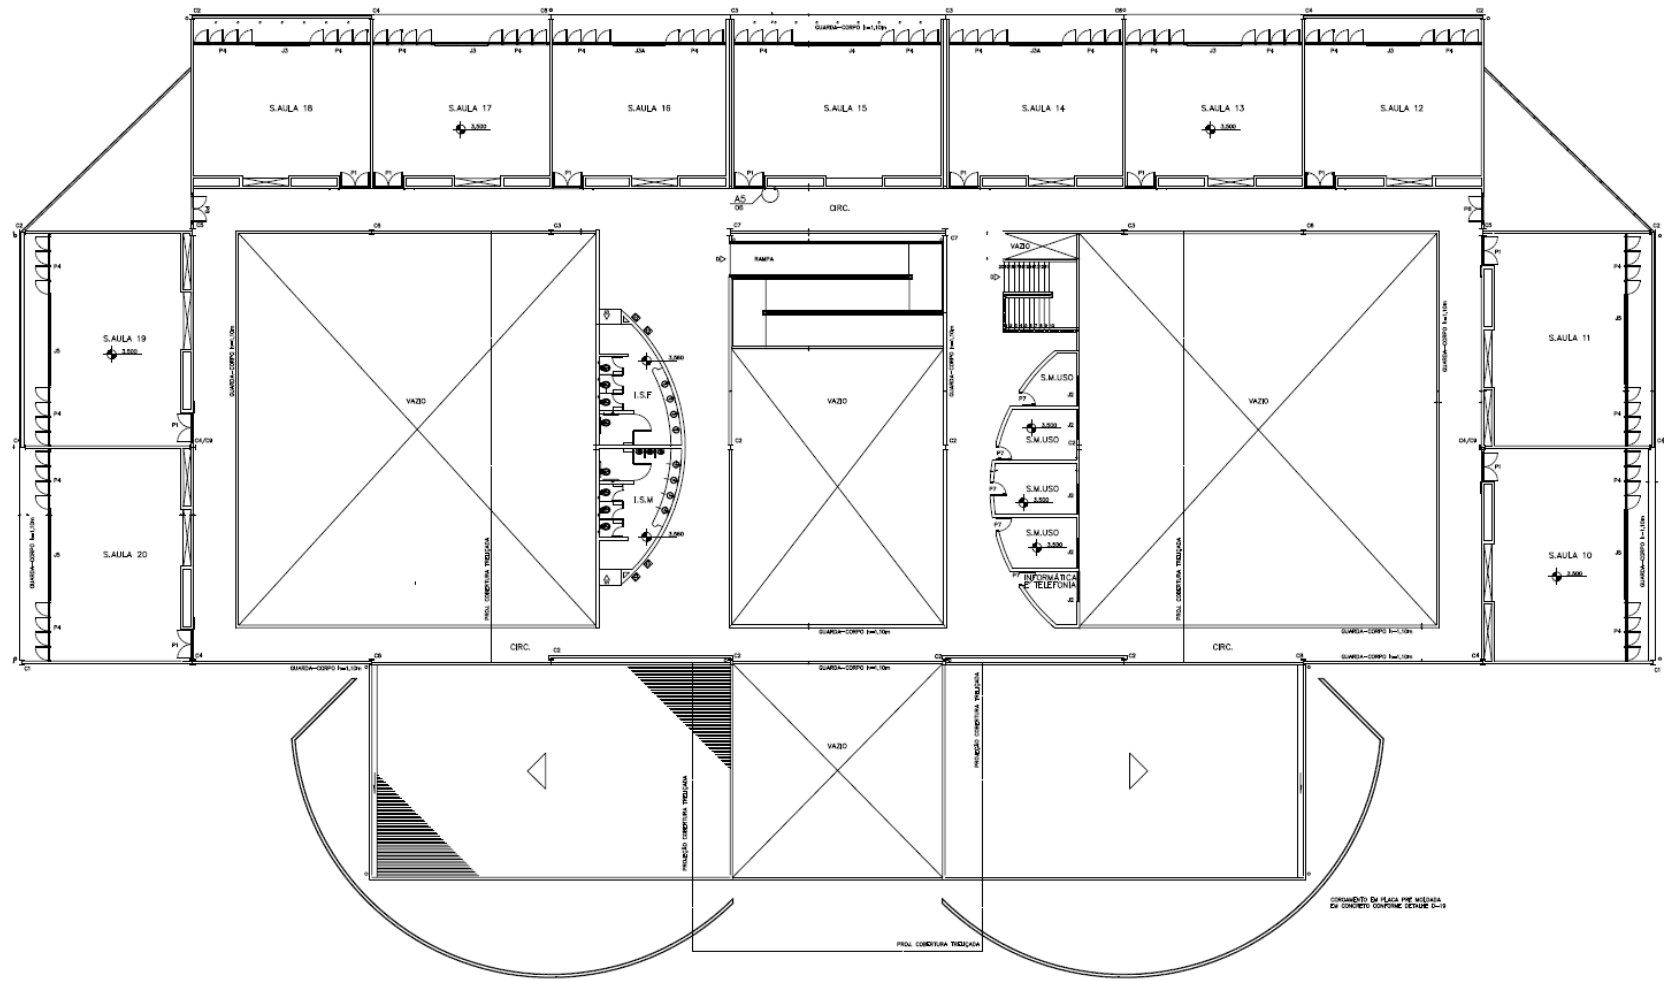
Planta Baixa do 2º Pavimento – PVB.
